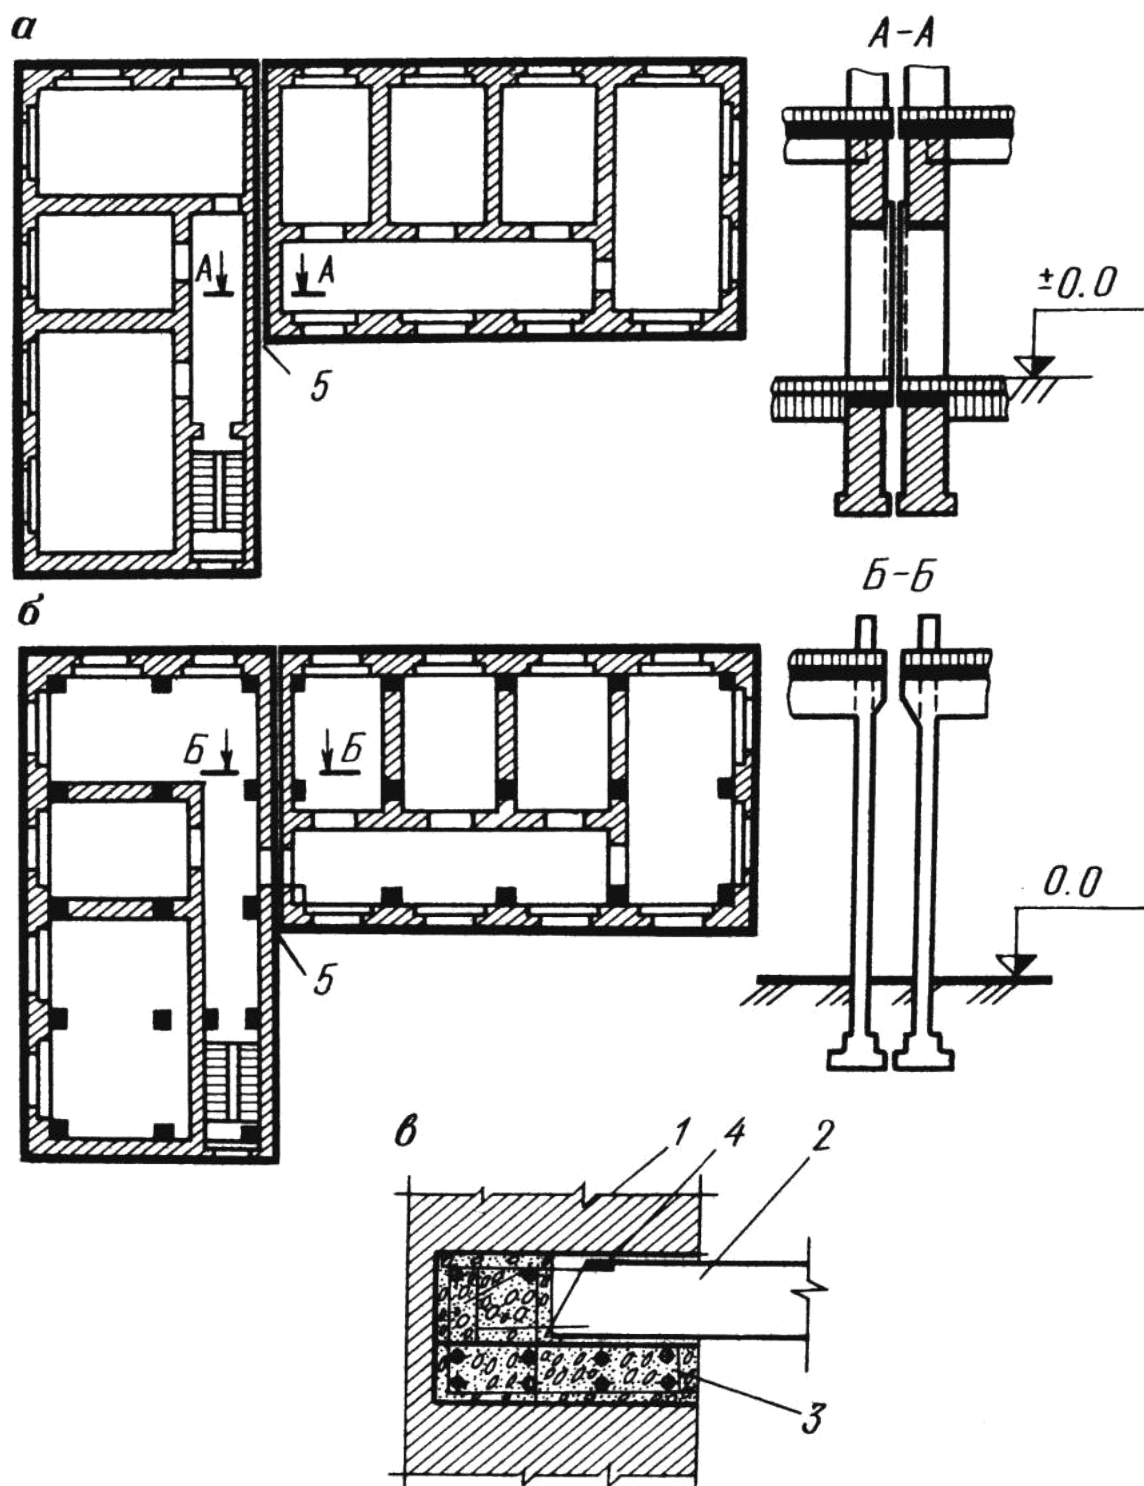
Схемы разрезки зданий на отсеки антисейсмическими швами: – при несущих стенах; б – при железобетонном каркасе; в – антисейсмический пояс: 1 – стена; 2 – панель перекрытия; 3 – железобетонный пояс; 4 – закладная деталь; 5 – антисейсмический шов
